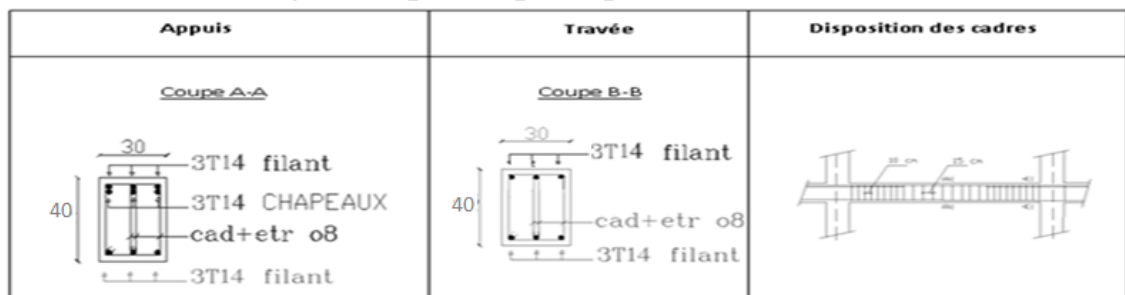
Coupe transversale de ferrailage des poutres principales (terrasse)
